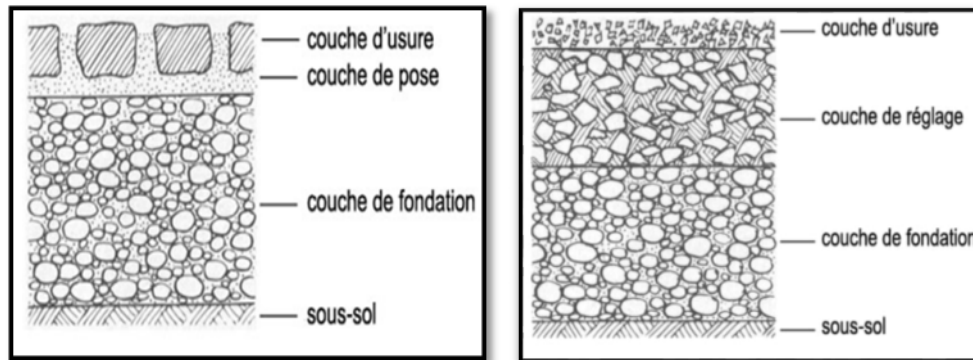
; coupe de revêtement avec une couche d'usure, Pavés ou dalles
